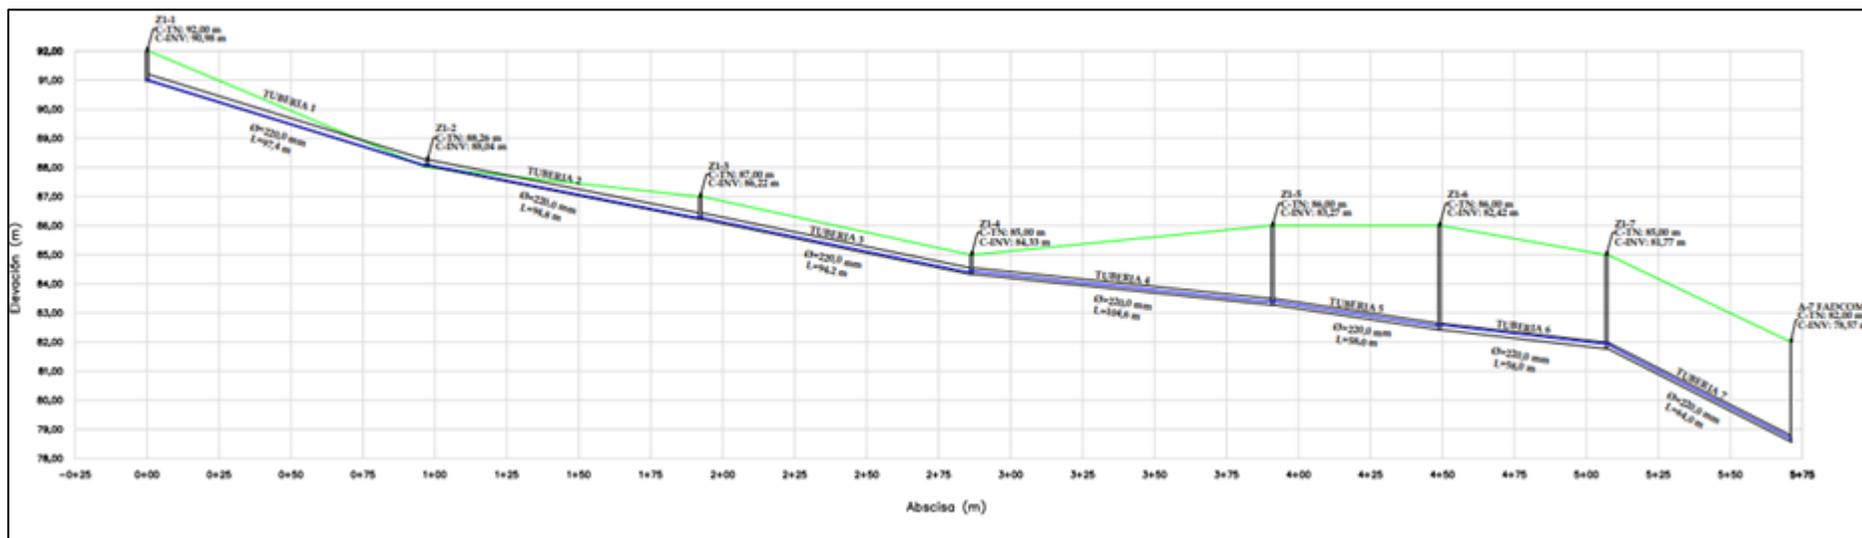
Propuesta de red de alcantarillado para las zonas de expansión.
